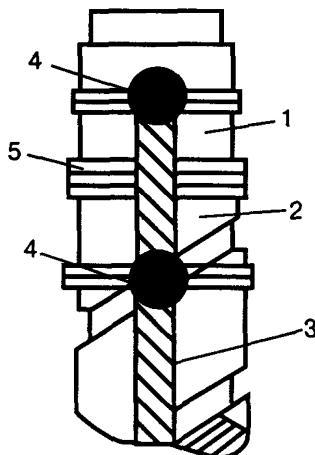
Заземление кабеля с металлической оболочкой и ленточной броней на концевой заделке:
